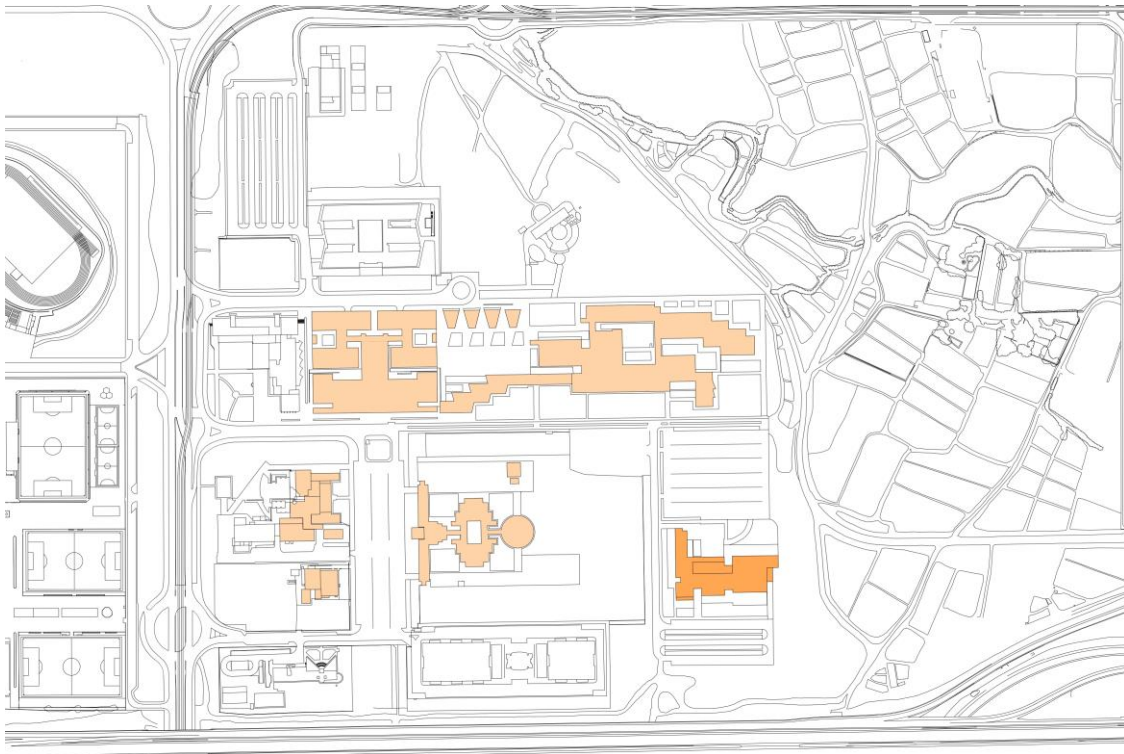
Plano de emplazamiento. Fuente. Elaboración propia
